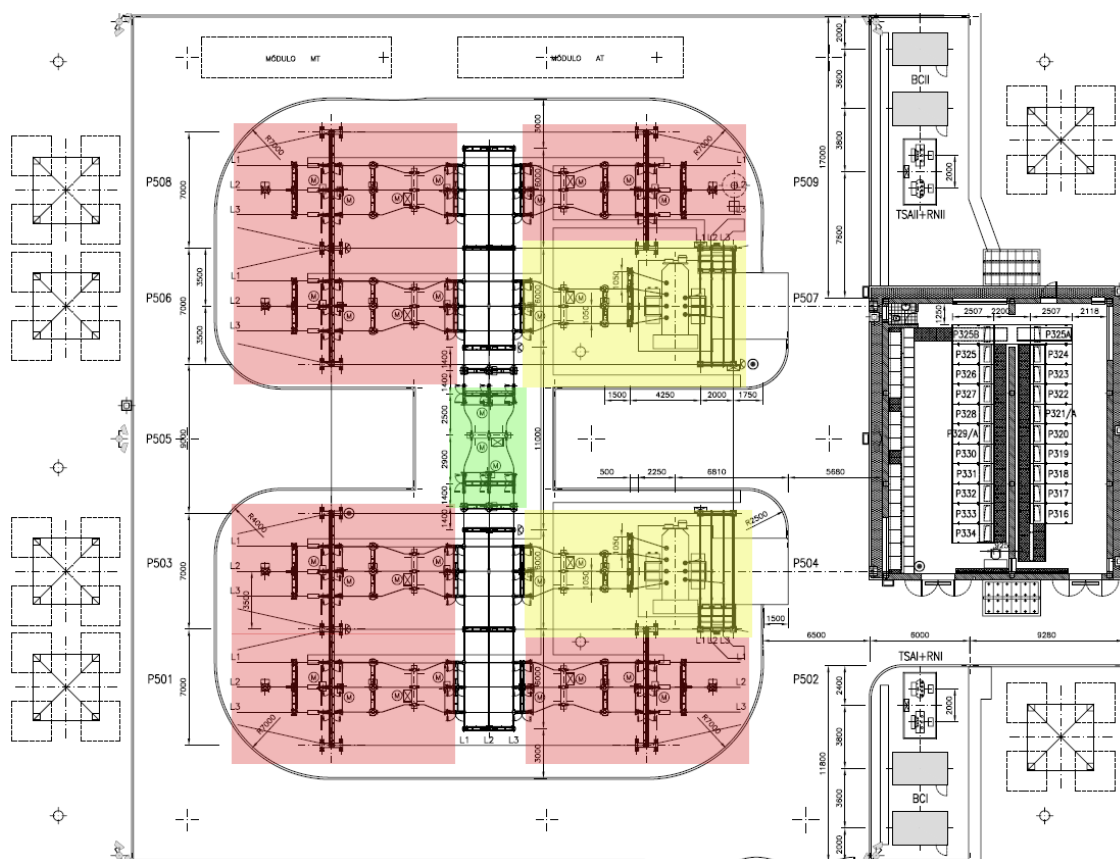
Pormenor da planta de implantação de subestação AT/MT, adaptado de [1]
